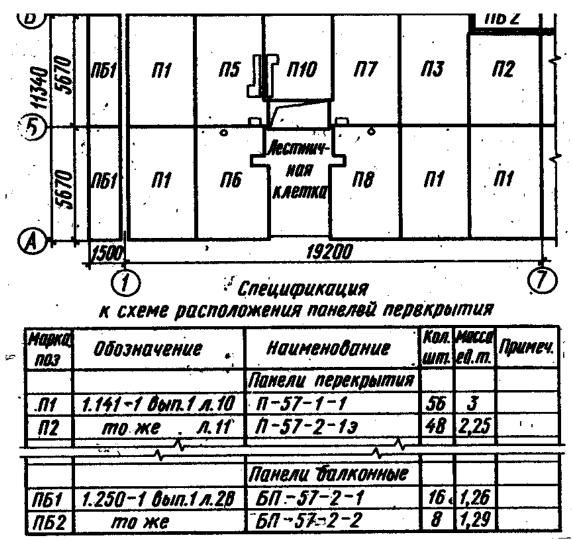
Схема расположения панелей междуэтажного перекрытия
